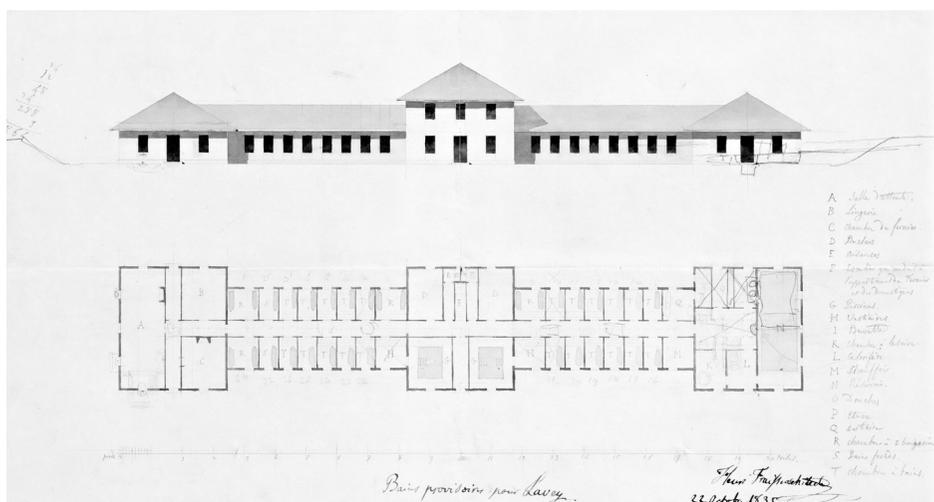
Lavey, bains, projet d'Henri Fraisse, élévation et plan, 1835 (ACV).
